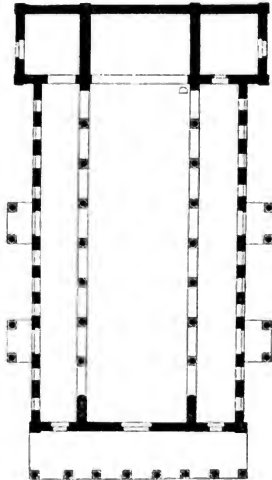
Basilika zu Hâss. Grundriss.
